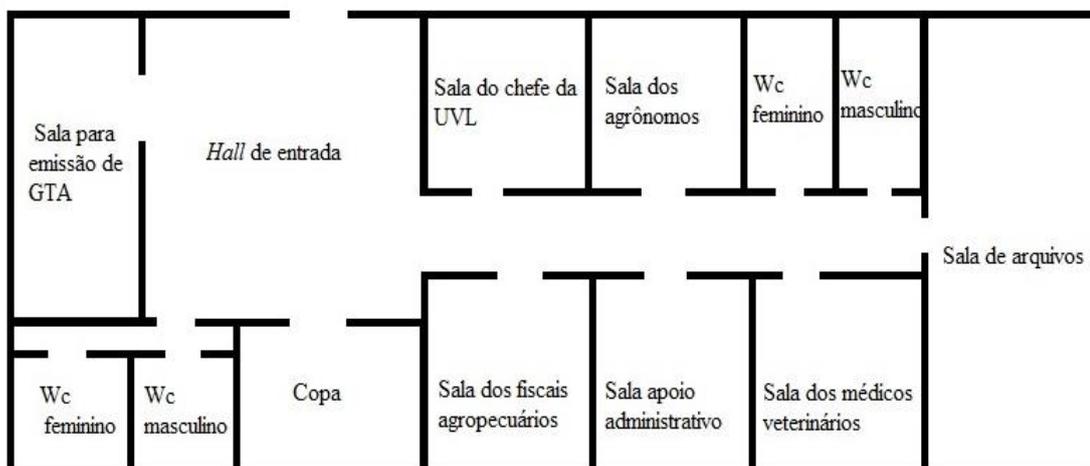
Planta baixa da UVL. Fonte: Arquivo pessoal, 2016
